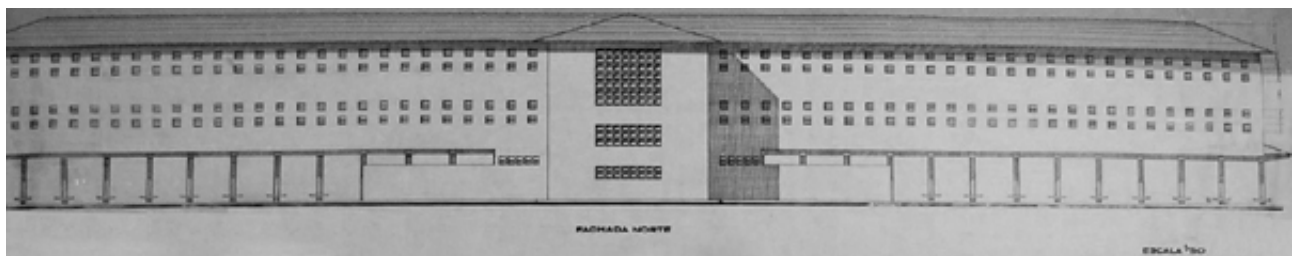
Projeto Original Fachada Norte – Fonte: EMOP.
